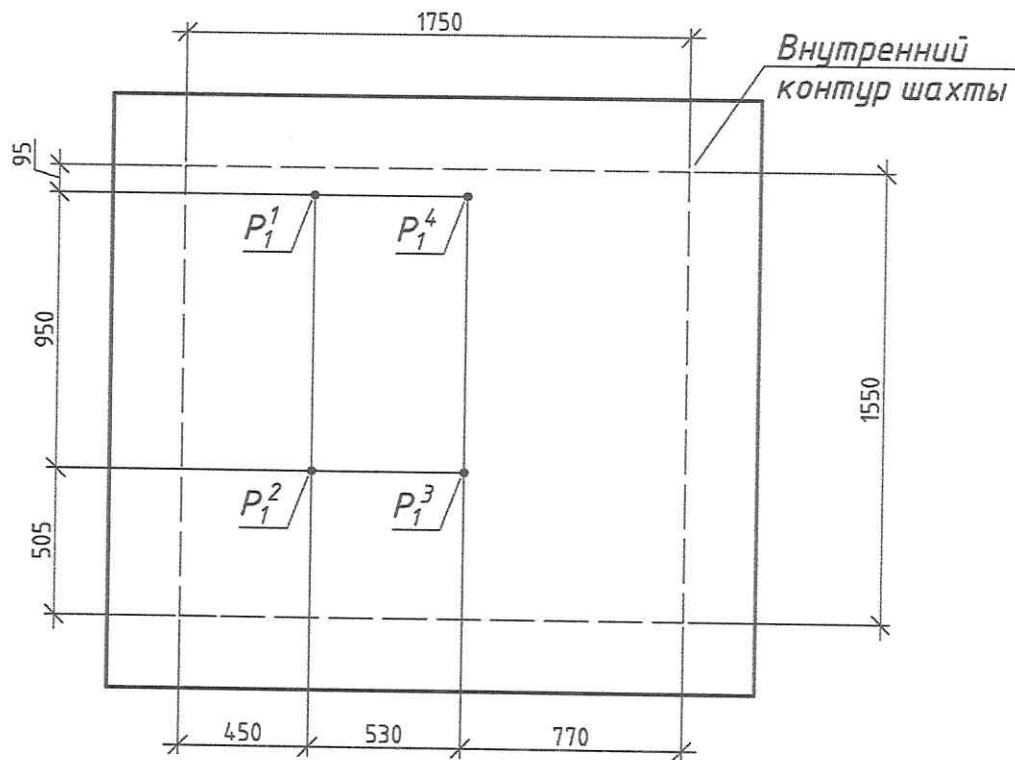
Нагрузки на плиту перекрытия шахты от лифтового оборудования.
